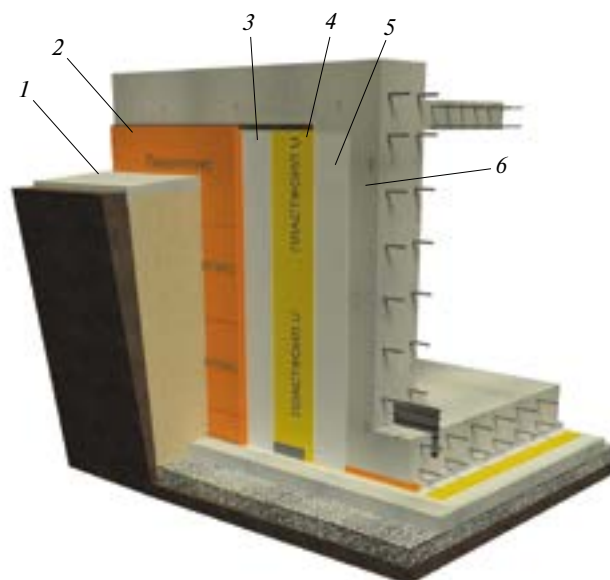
Замкнутая система тепло- и гидроизоляции: 1 – грунт обратной засыпки; 2 – теплоизоляция ПЕНОПЛЭКС®; 3 – геотекстиль, 300 г/м²; 4 – гидроизоляция PLASTFOIL® GEO; 5 – геотекстиль, 500 г/м²; 6 – гидроизолируемая конструкция
